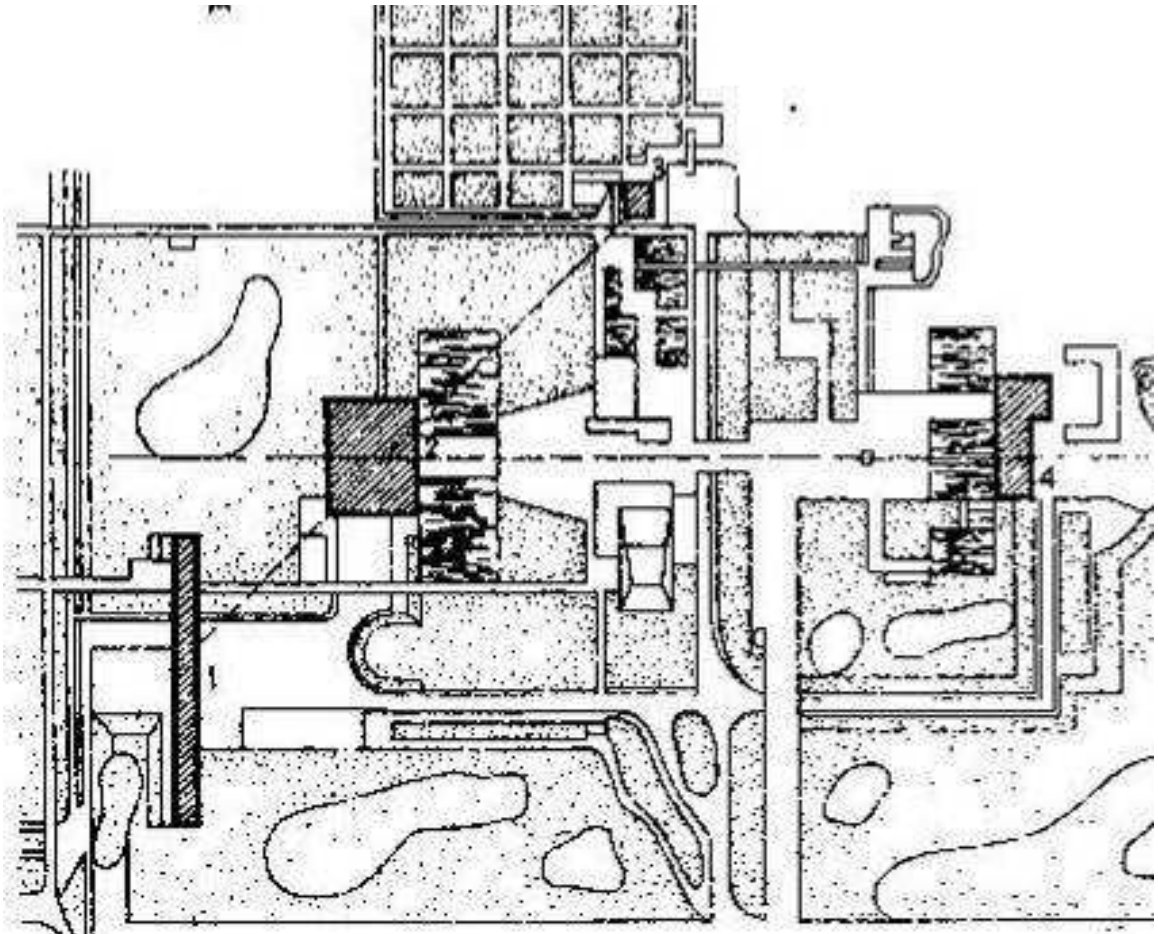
Примеры размещения на площадях общественных зданий:
